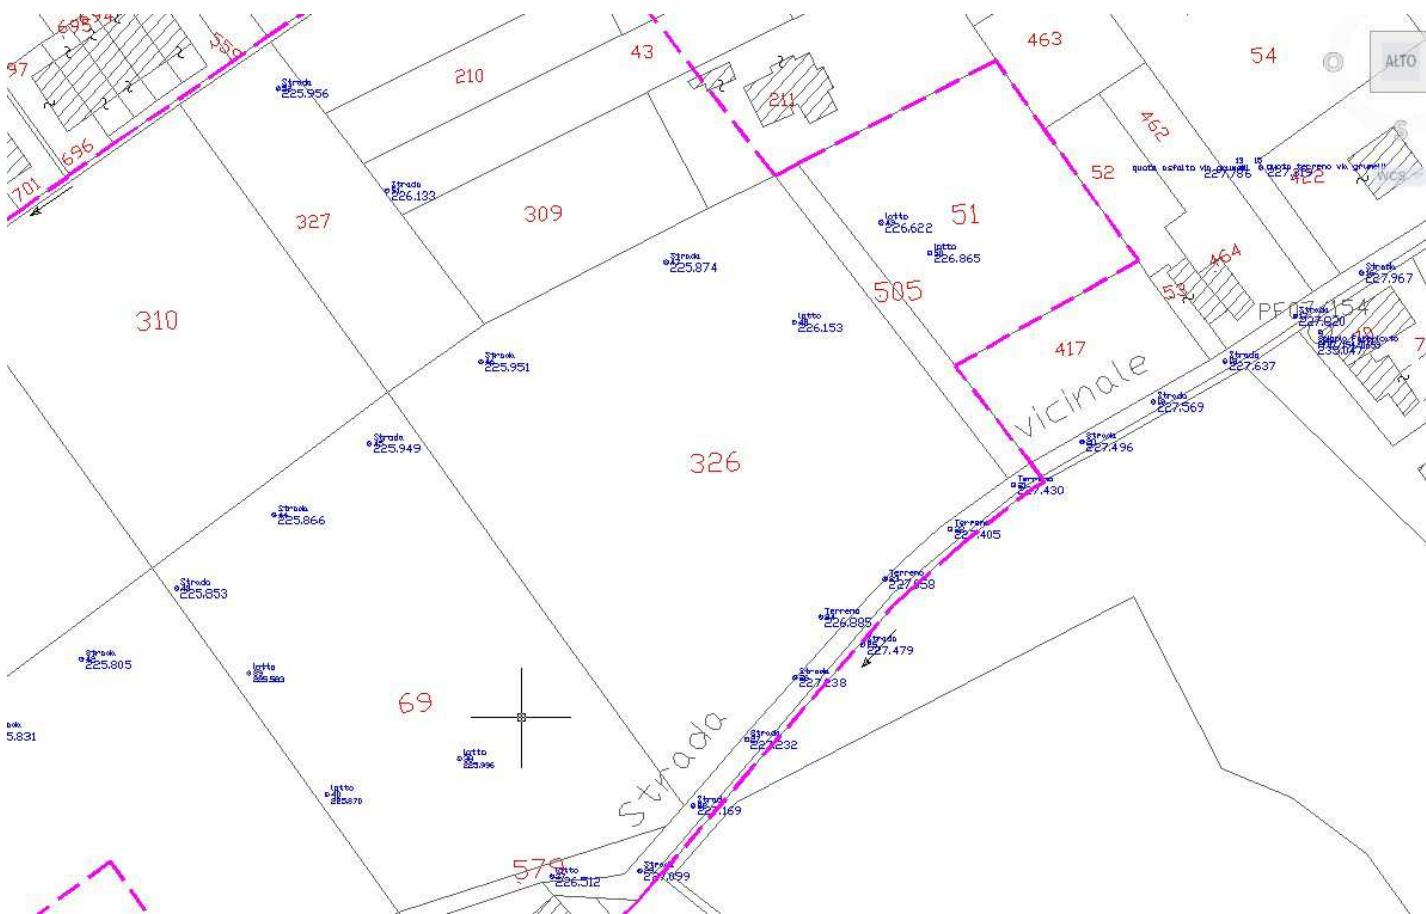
Planimetria generale dello stato dei luoghi su planimetria catastale con inserimento dei punti del rilievo battuto - Zoom B -
